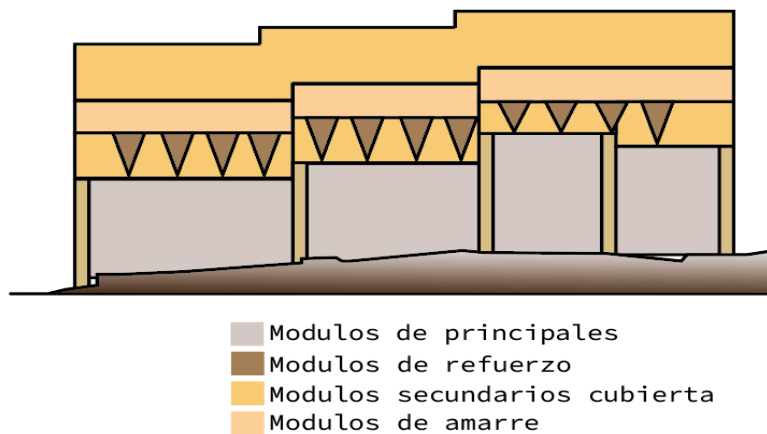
Esquema de geometría en planta casa mil guaduas](#)
